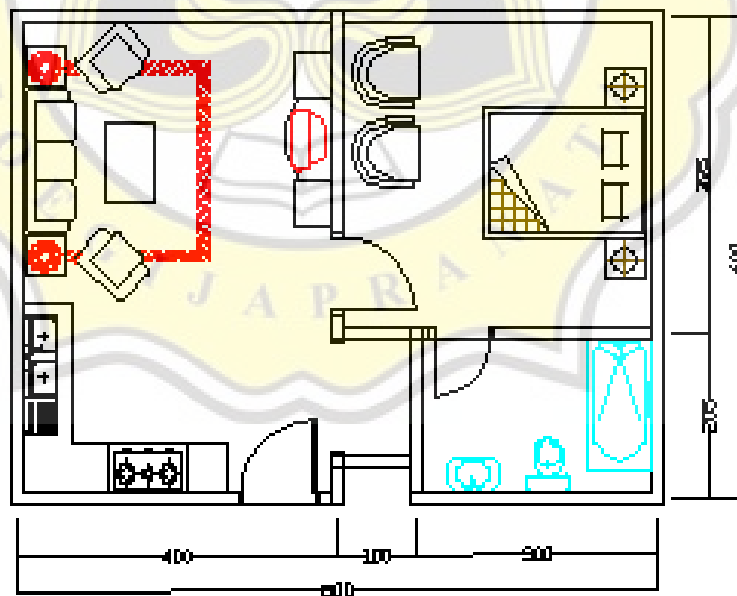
Layout Ruang Apartemen 2 Bedroom
